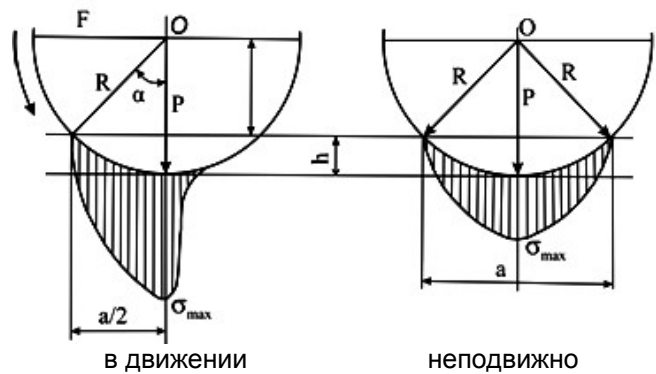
Схема распределения давлений под колесом пневмокатка на болотной поверхности
